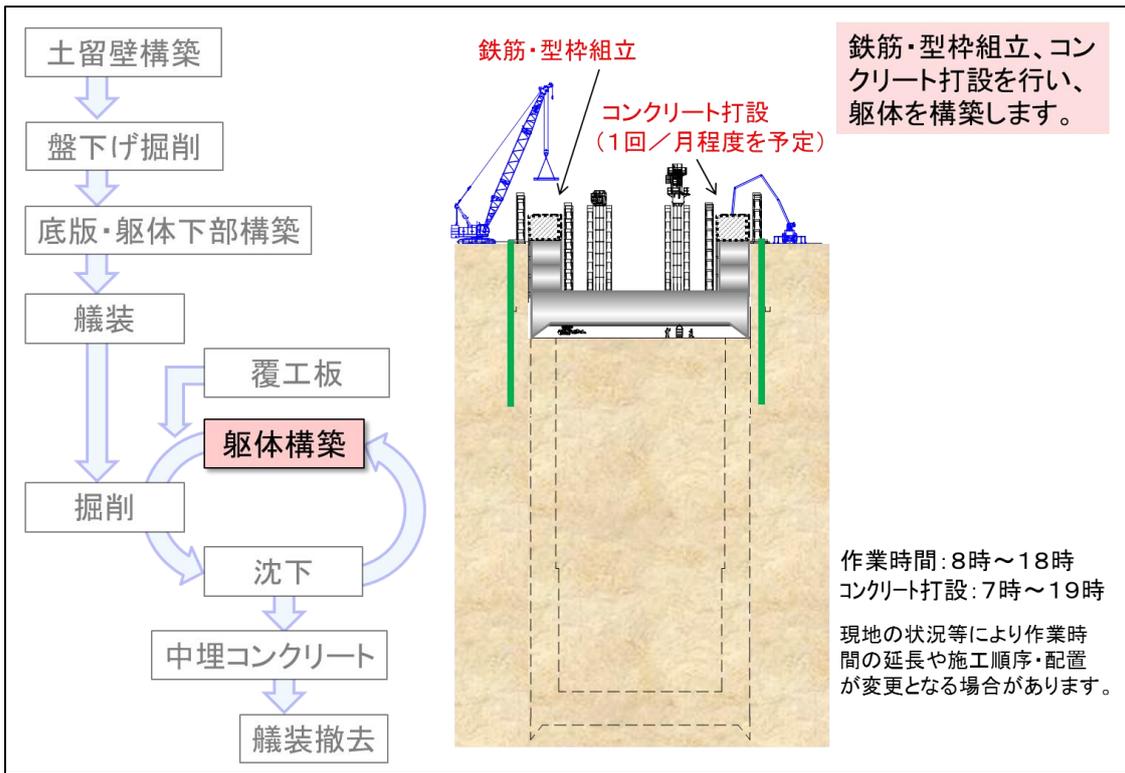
(9) ニューマチックケーソン工（躯体構築）の施工手順
